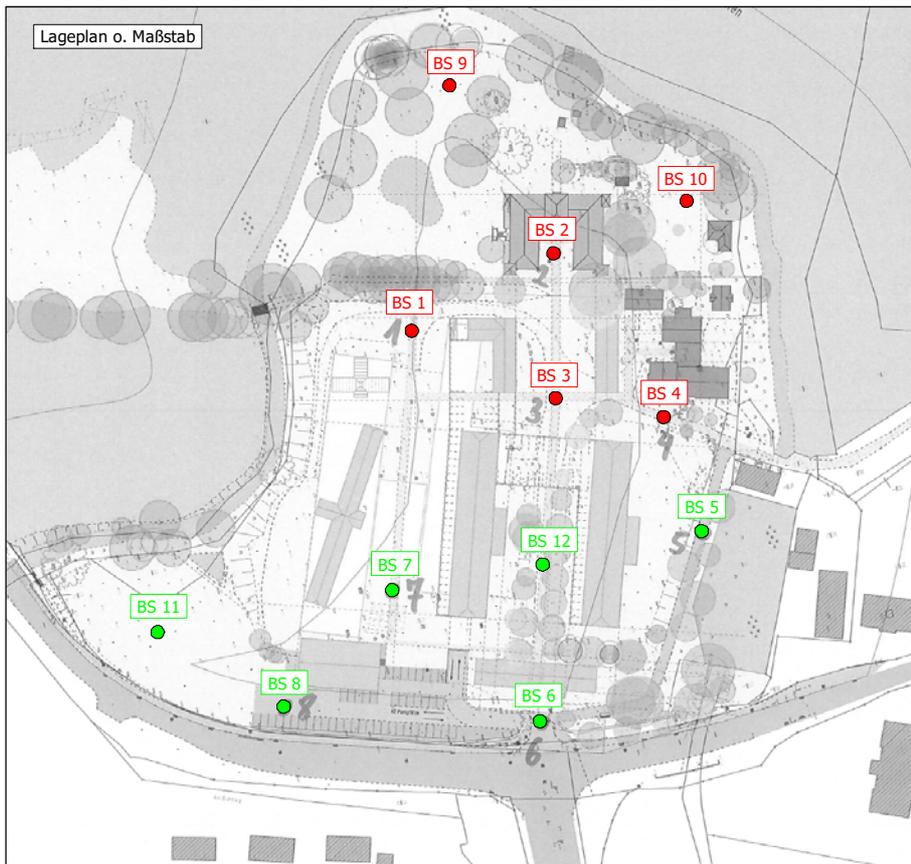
Lageplanausschnitt s. Anl. 1.1 (o. M.)
